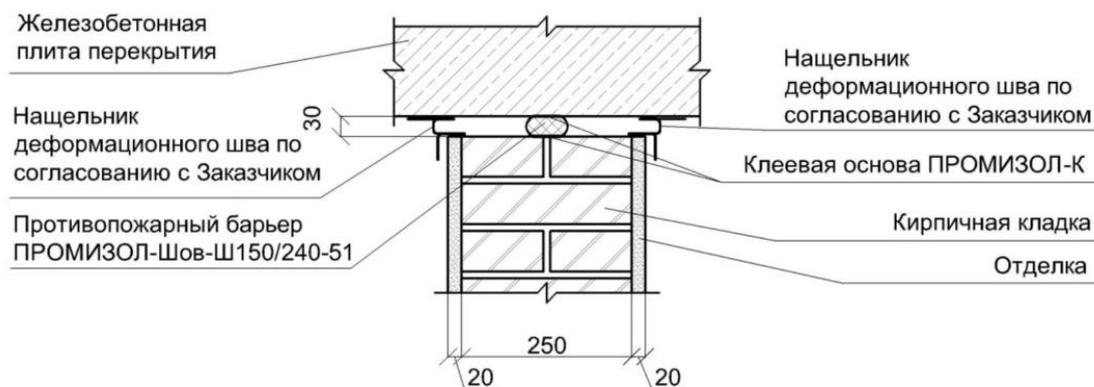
Устройство примыкания перегородок к плите перекрытия (шириной 30 мм с пределом огнестойкости EI-240)
